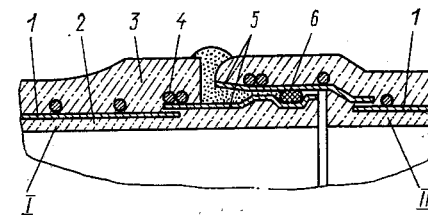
Сечения стыков двух напорных железобетонных труб с металлическим цилиндром:
